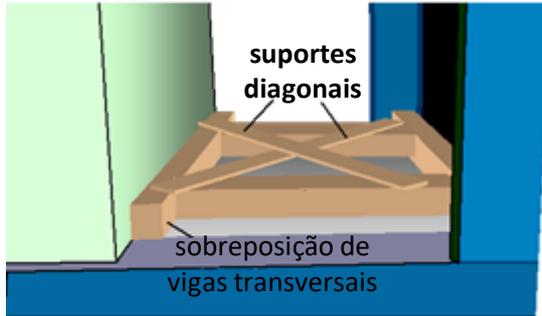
Estrutura de escoramento mostrando sobreposição das vigas transversais e escoras diagonais
